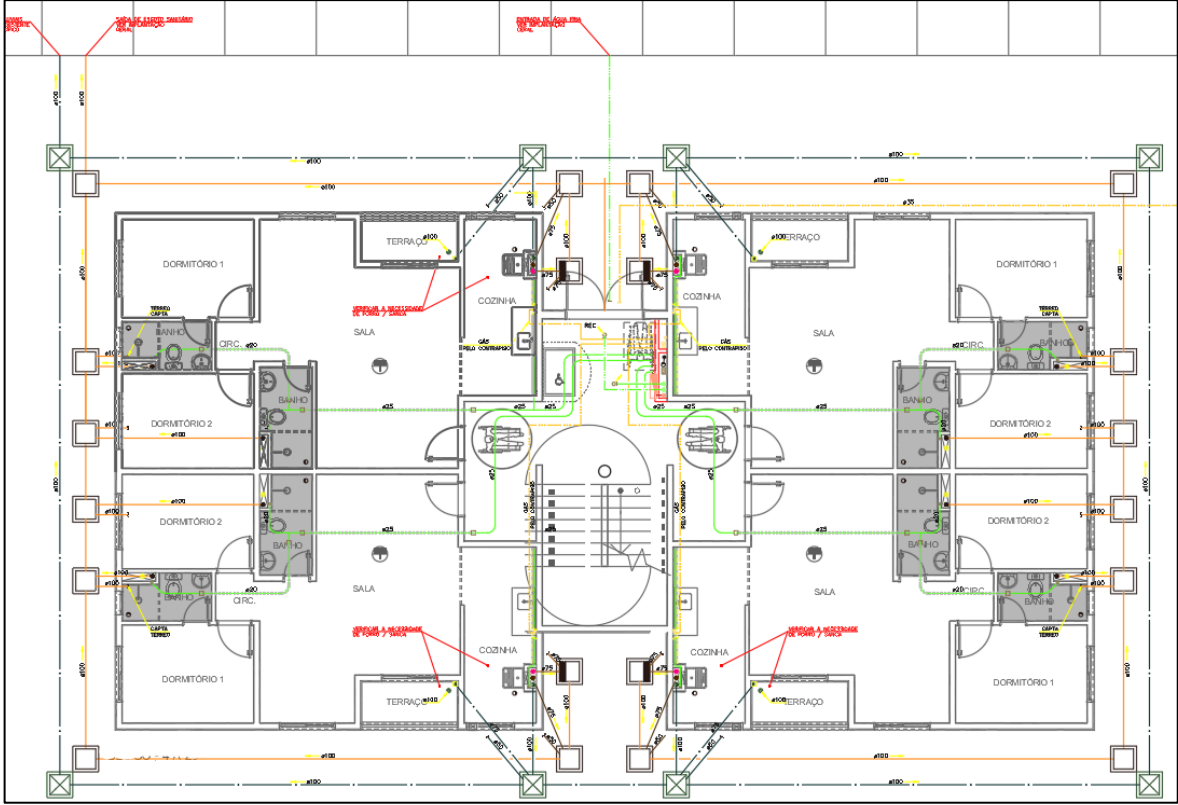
Planta da 1ª fiada do pavimento tipo em Projeto Executivo
